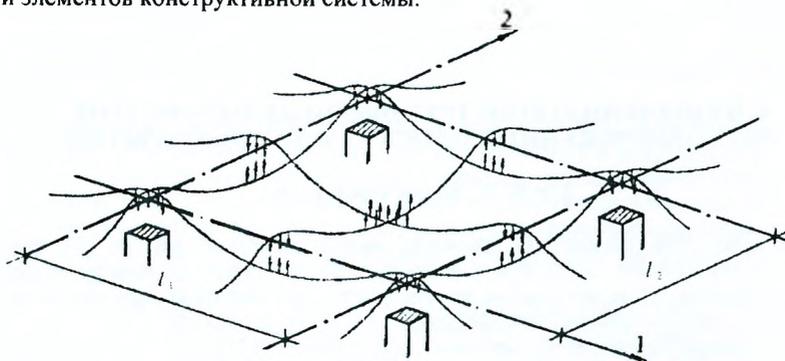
Схема эквивалентных нагрузок от пост-напряжения внутренней плиты перекрытия
